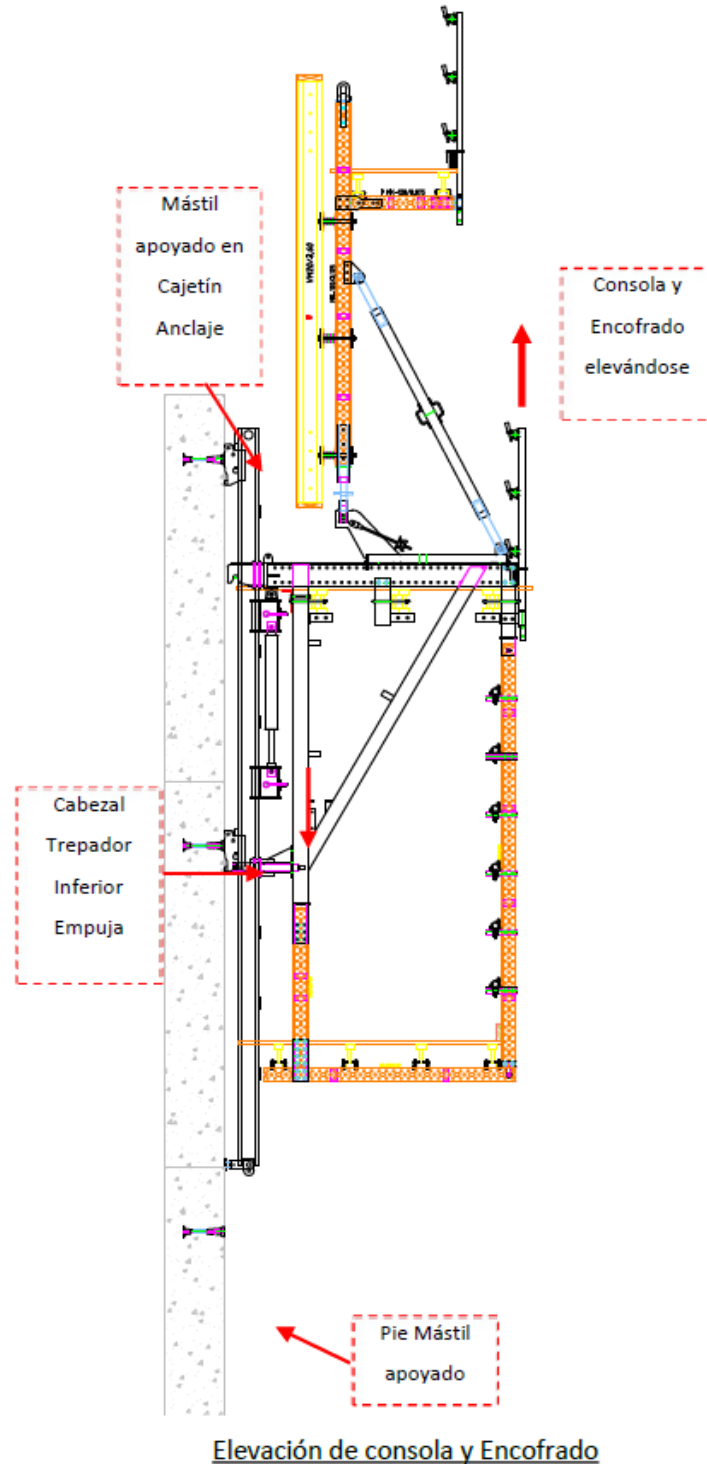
Se muestra el procedimiento general de elevación de la consola junto con el encofrado.
